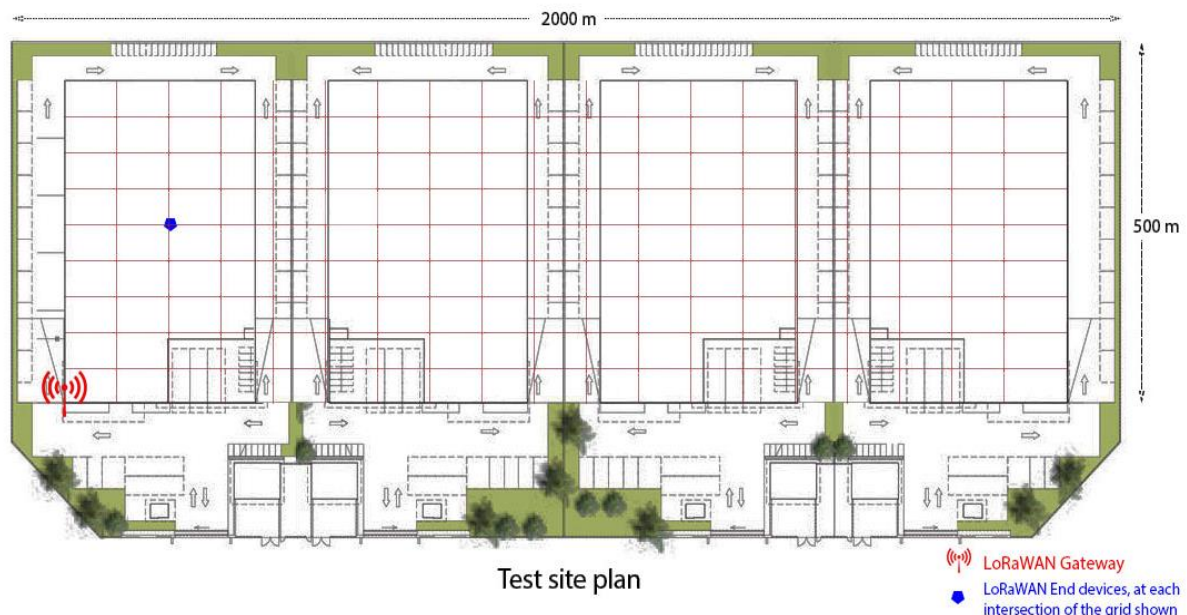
Disposición de los dispositivos dentro de la planta industrial.
